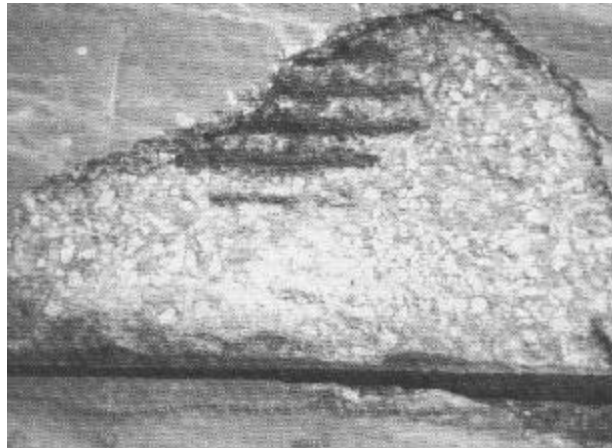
Délamination à la base d'une poutre caisson en béton armé.
